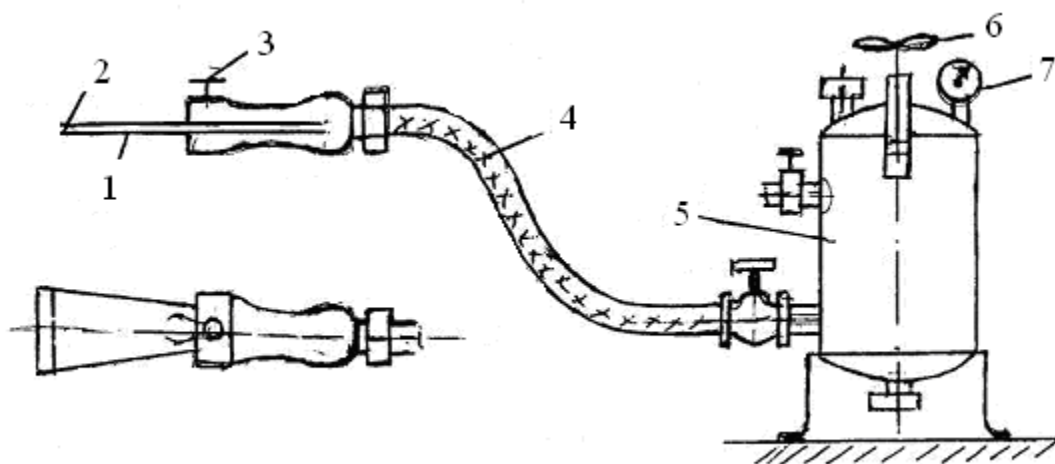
Механизированный шпатель конструкции С.А.Суслова:
